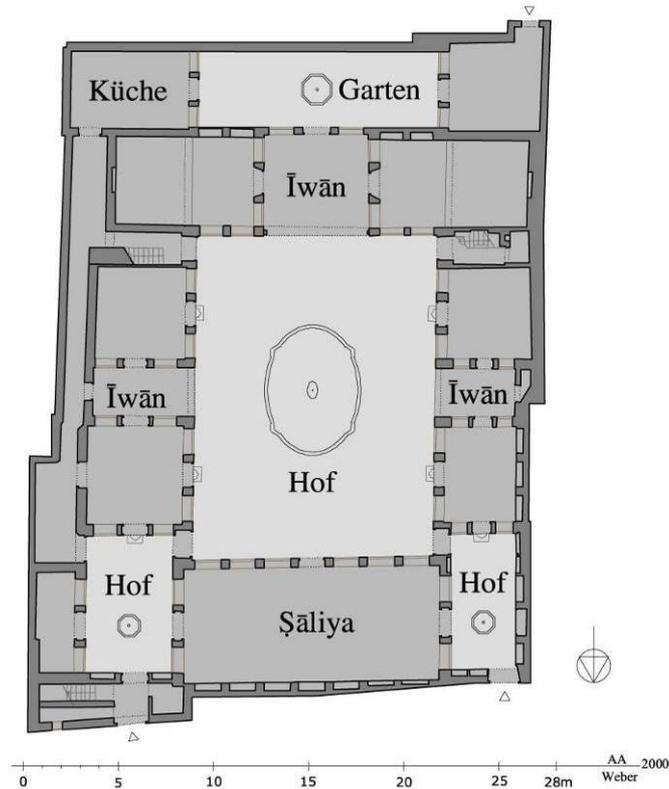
Bayt Ḥasan al-Quwatlī (ad-Daqqāqīn), Grundriss EG
